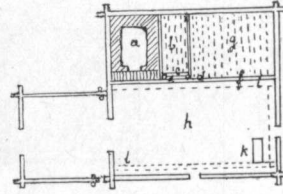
Grundriss des hauses in abb. 5.
